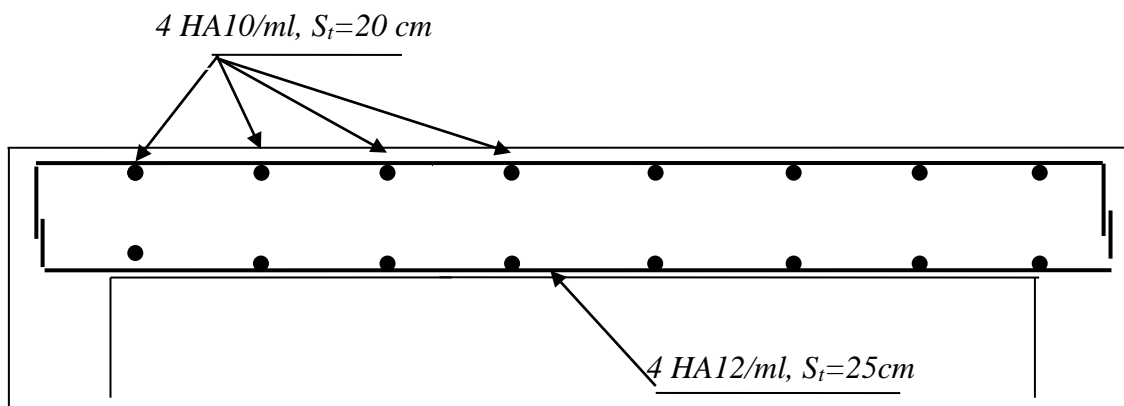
Plan de ferrailage de la salle machine suivant x-x. [1] .
